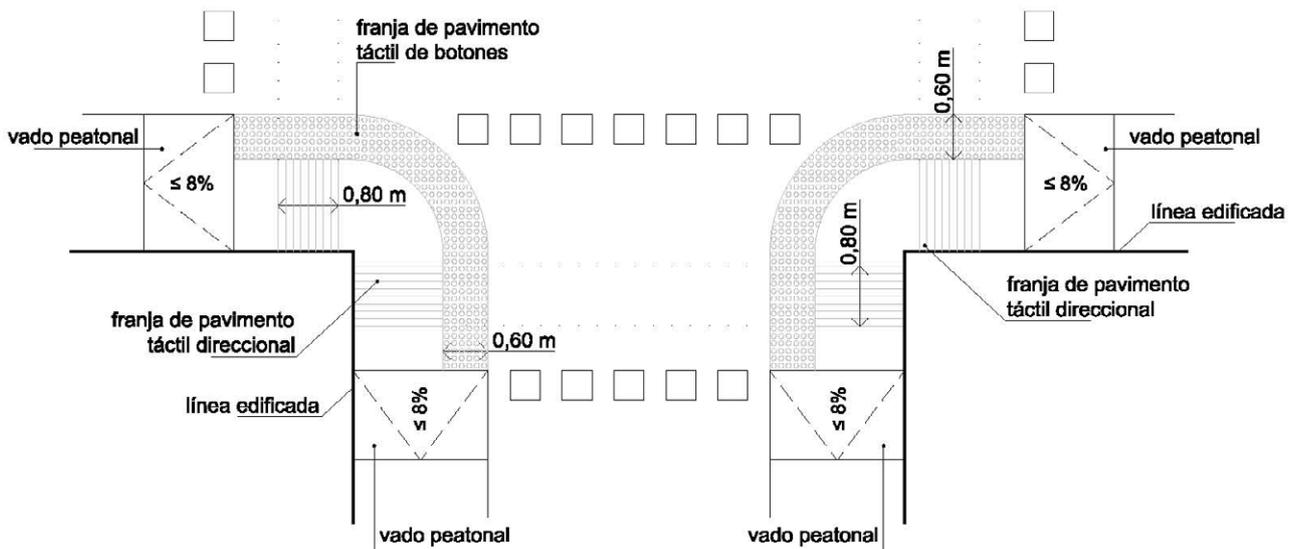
Cruce a distinto nivel: ejemplo de aplicación de la señalización táctil en esquinas donde la acera se rebaja al nivel de la calzada
